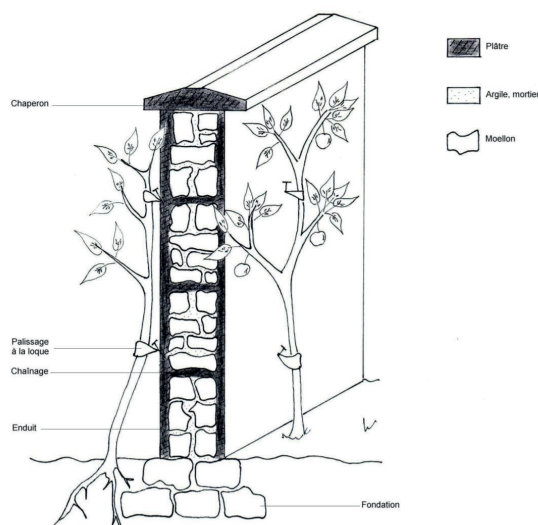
Coupe détaillant la construction d'un mur à pêche en plâtre.
